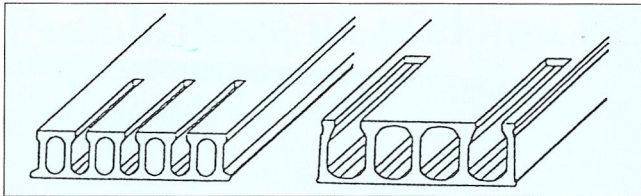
Příklad vertikálního sprážení stropní desky s podporujícím nosníkem / *Example of the vertical connection of a floor slab to an interior supporting beam
